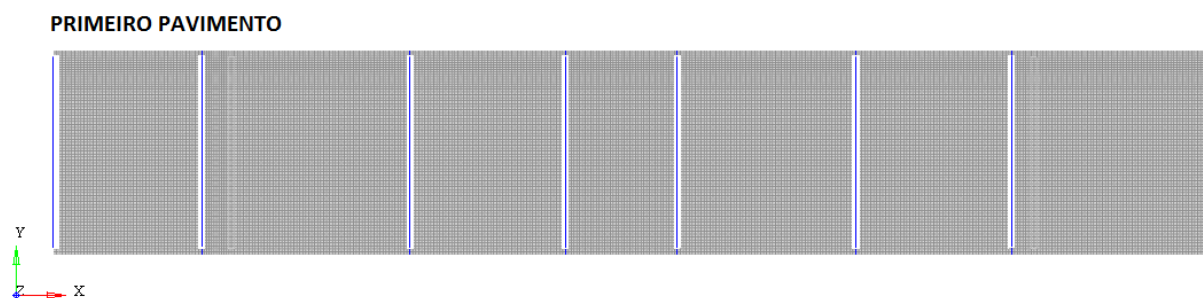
Malha de aço adicionada embaixo das lajes do primeiro pavimento
